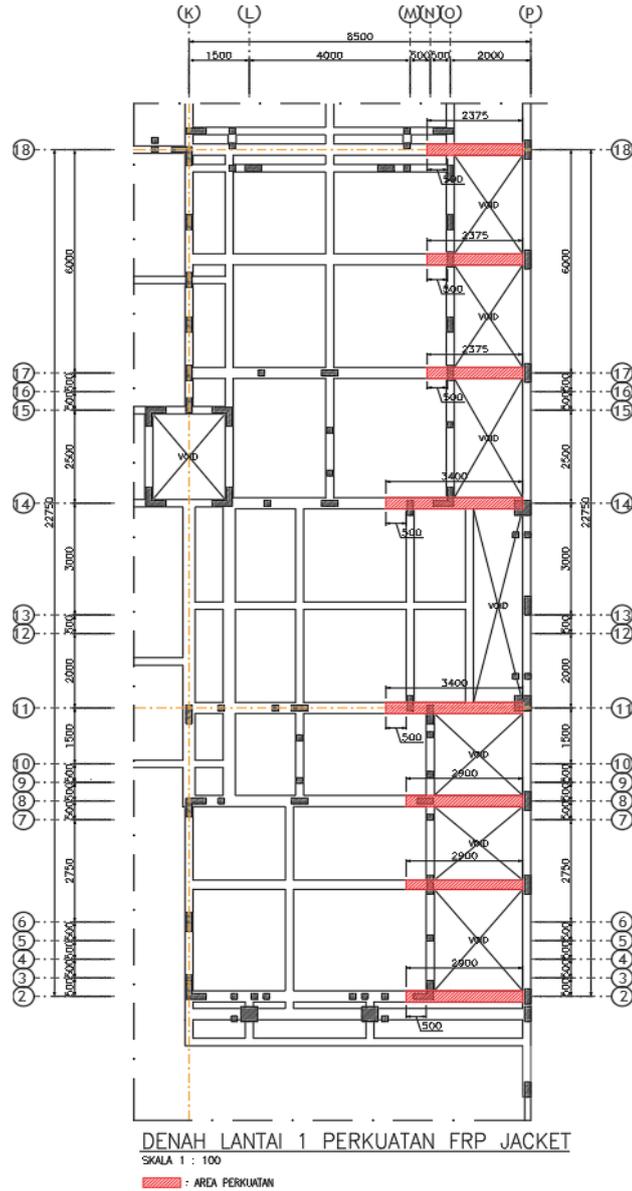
Denah struktur perkuatan *jacketing* beton.
